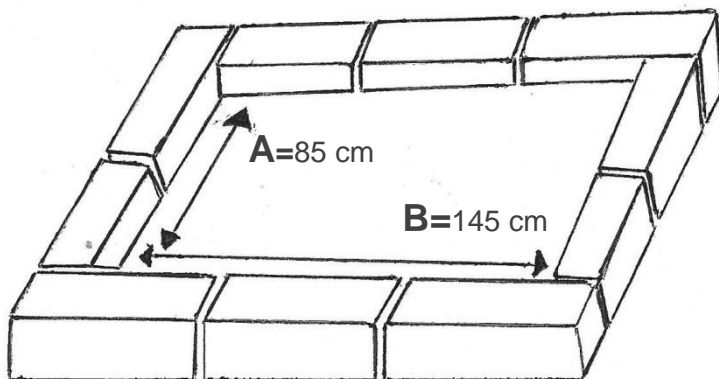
Schéma de coffrage des dalles de défécation de la latrine Ecosan
